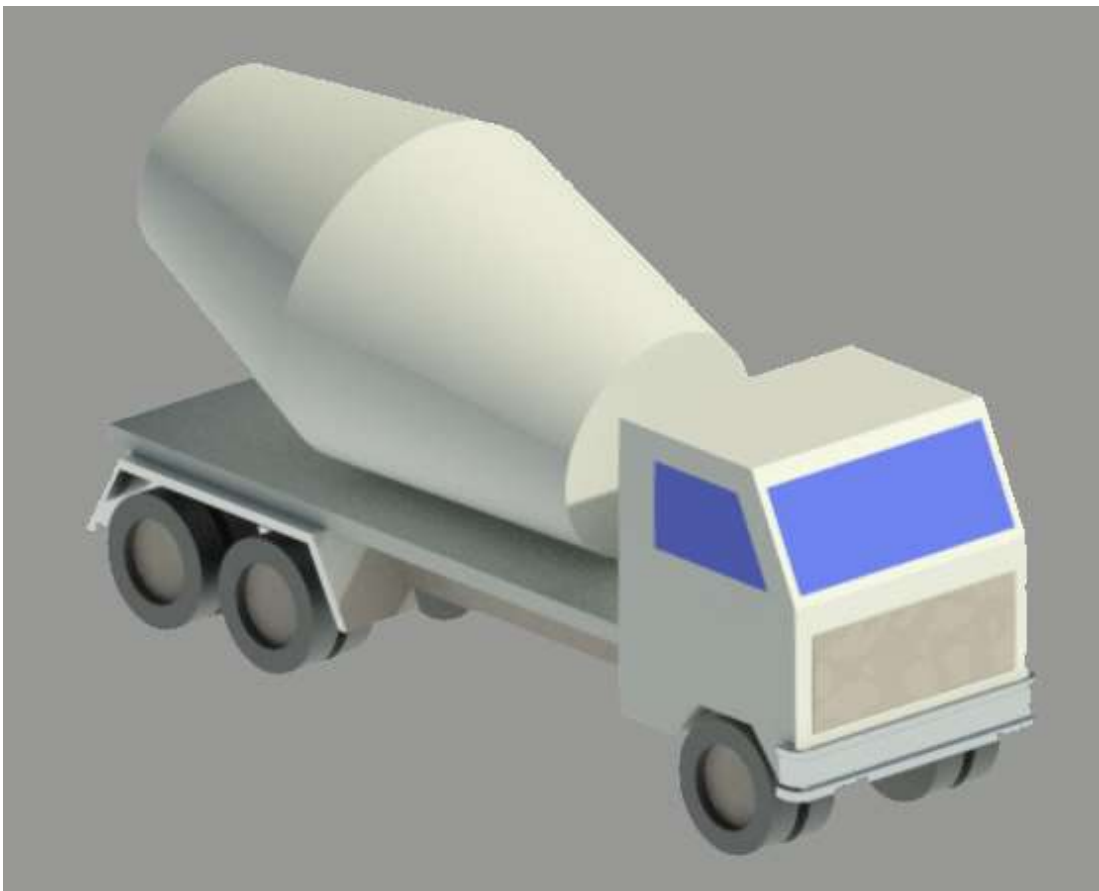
Nel modello, indicheremo il mezzo autobetoniera con questo oggetto parametrizzato.
